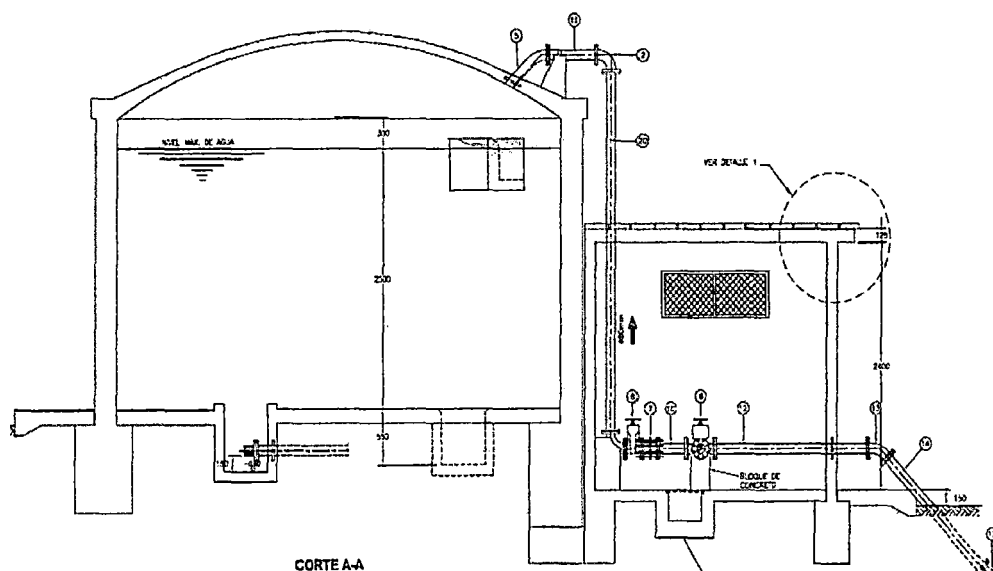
Detalle Típico de Reservorio Proyectado de 50m<sup>3</sup> para la Obra.
